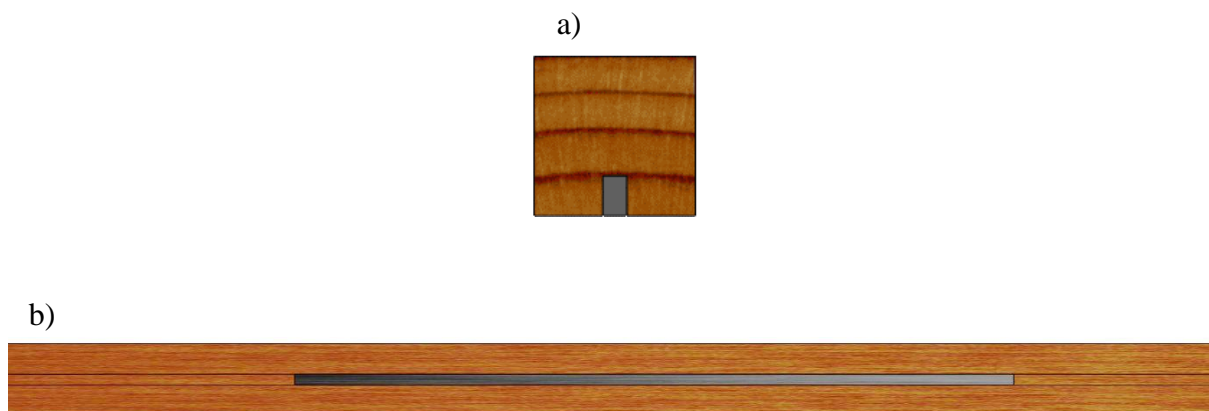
a) Vista de topo; b) vista de baixo.
